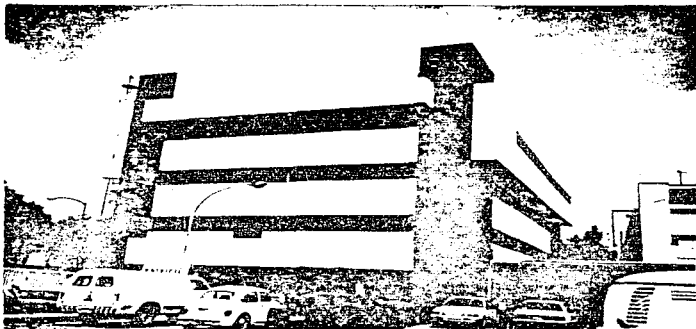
VISTA GENERAL DEL EDIFICIO, FACHADA PONIENTE
